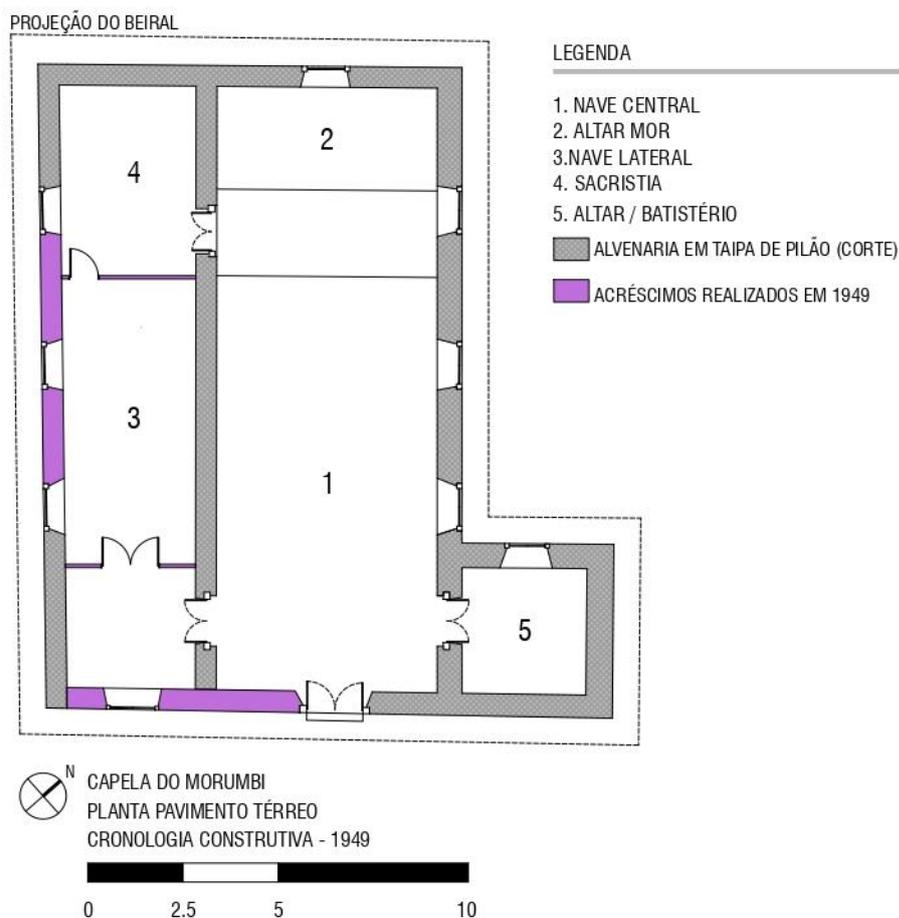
Capela do Morumbi, Planta da situação em 1949 do pavimento térreo com destaque para as intervenções realizadas por Warchavchik – Cronologia Construtiva. Fonte: Autora.
